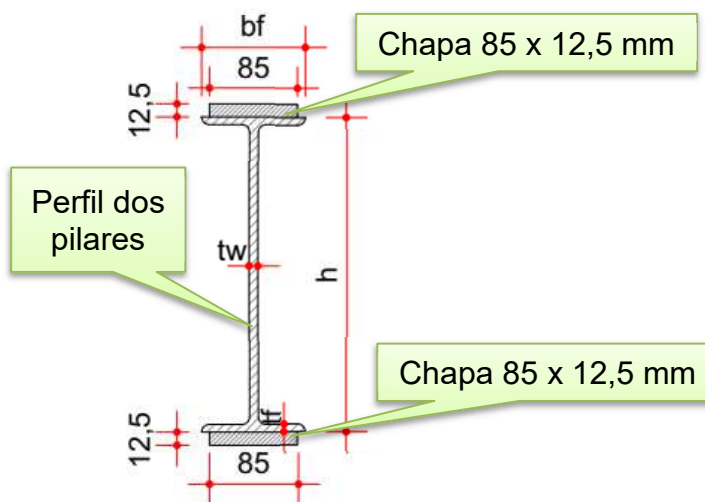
SEÇÃO DOS PILARES REFORÇADOS - ESPAÇAMENTO TÍPICO
